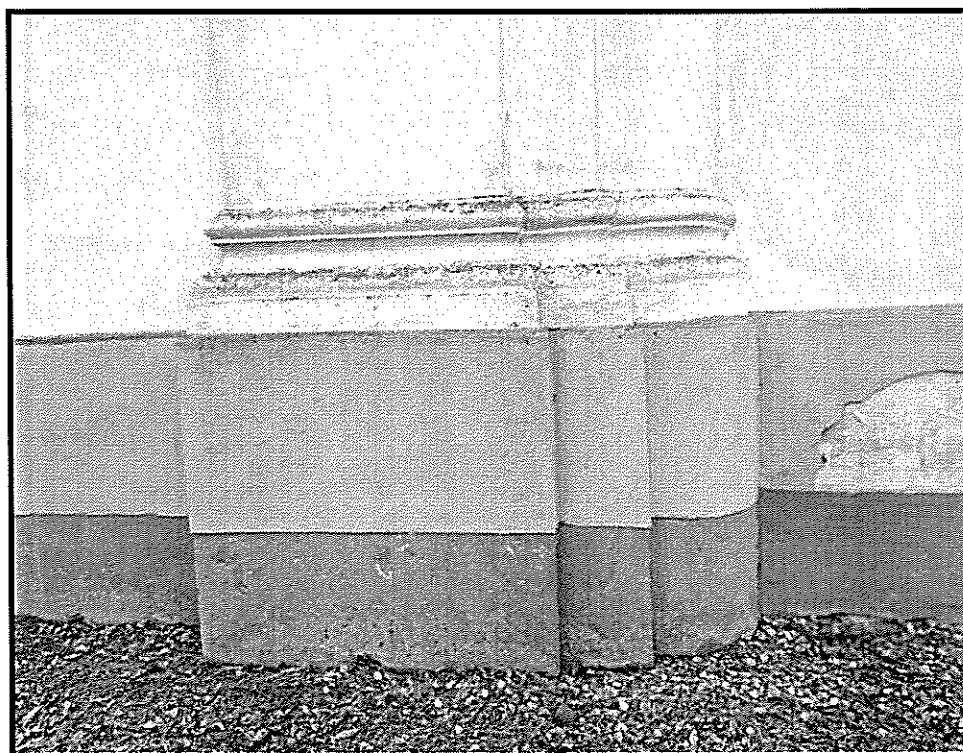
Rozległe uszkodzenia tynku cokołu elewacji wschodniej.
